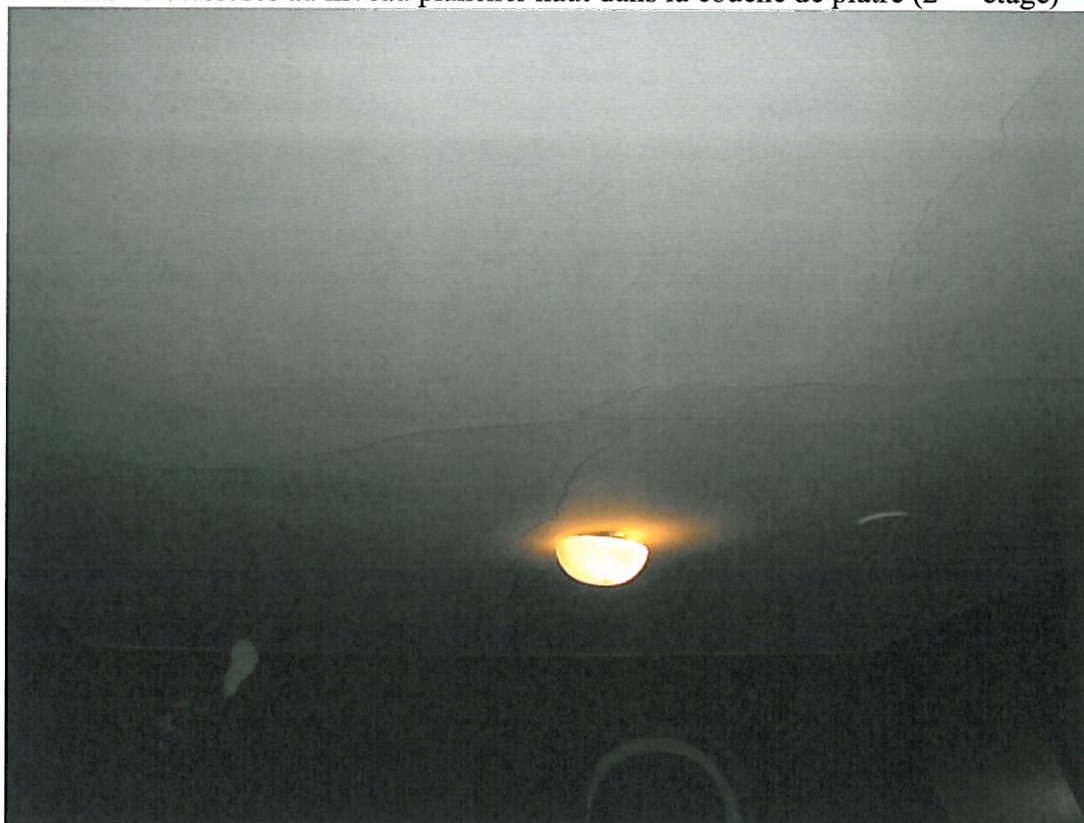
fissures au niveau plancher haut dans la couche de plâtre (2<sup>ème</sup> étage)
